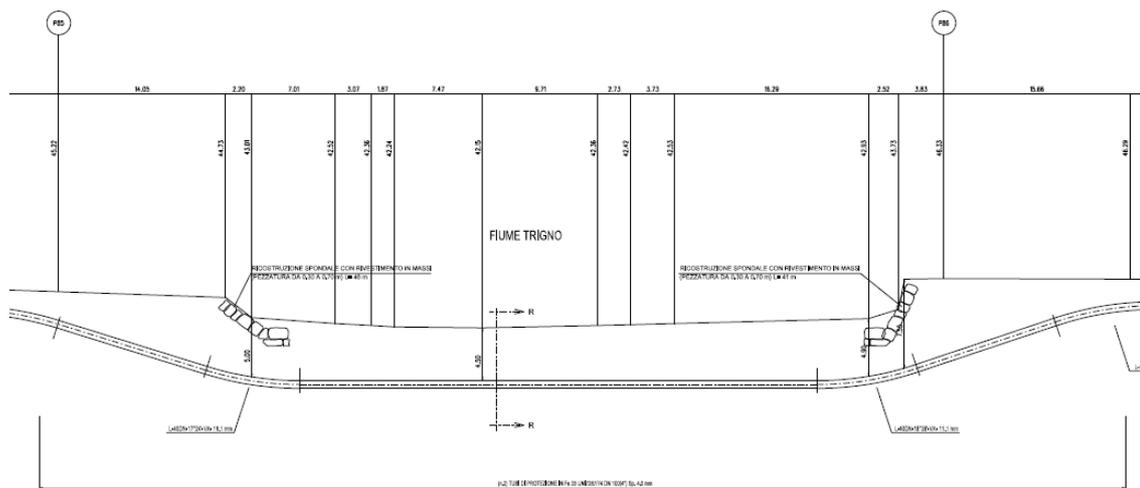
Attraversamento fiume Trigno - Sezione schematica di progetto
